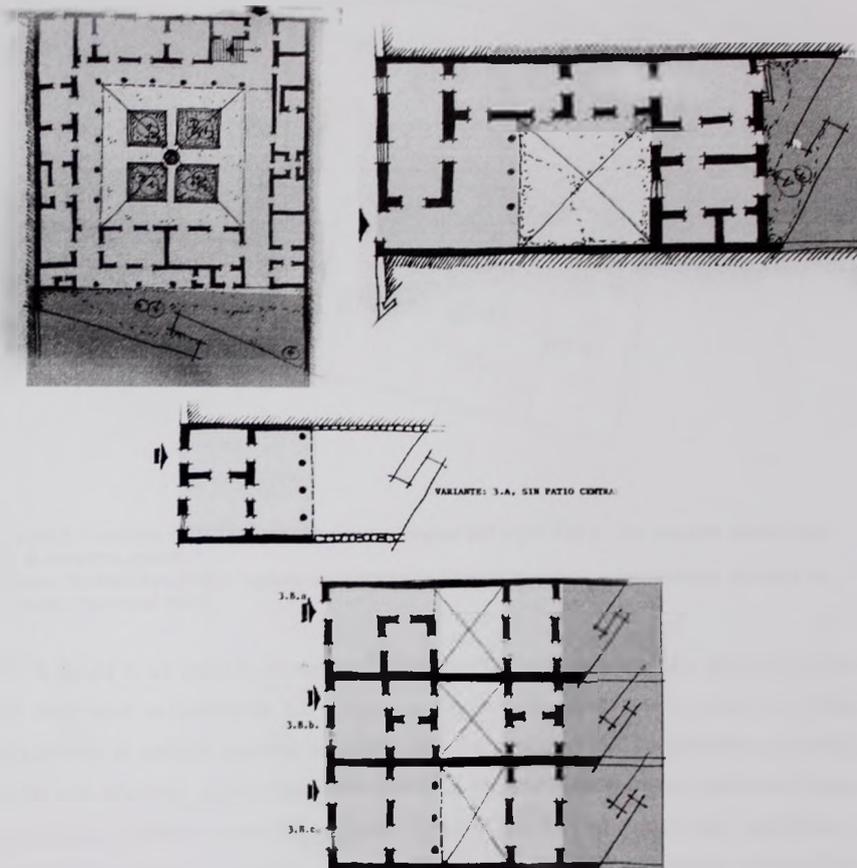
Ejemplo de plantas de vivienda de tipología colonial
